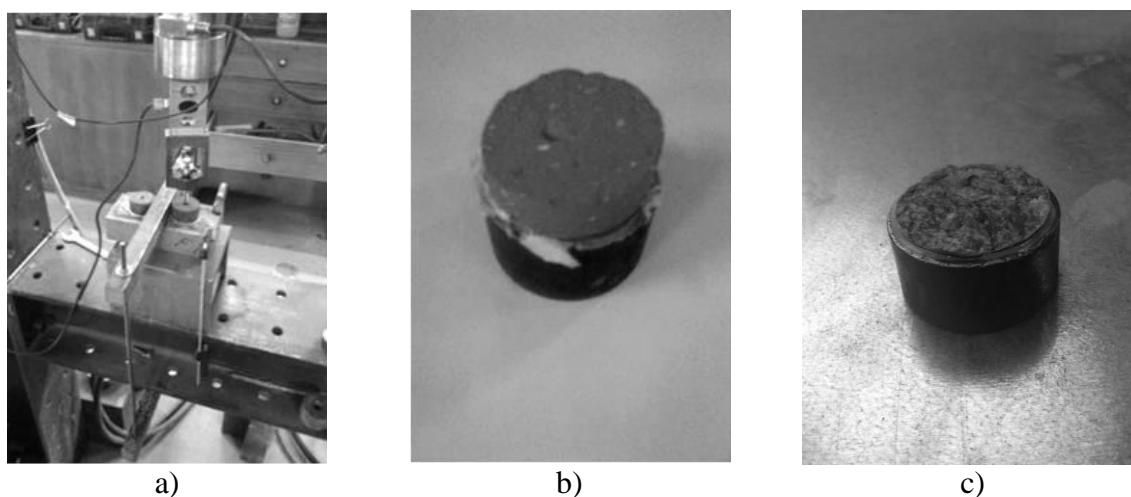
Ensaios Pull-off: a) Prensa hidráulica; b) Pormenor do modo de rotura pelo tijolo; c) Pormenor do modo de rotura pela ligação do sistema (resina).
